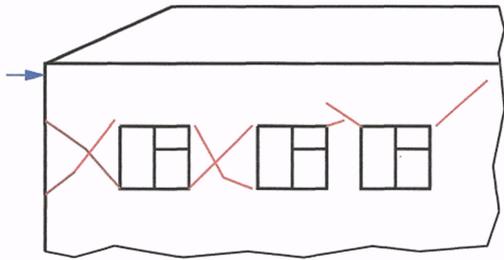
Разрушение угловых и разнопрочных простенков
